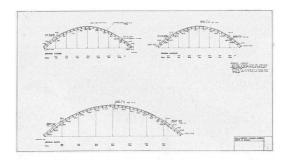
Secciones constructivas y estructurales de la casa Dieste (Archivo Dieste)
